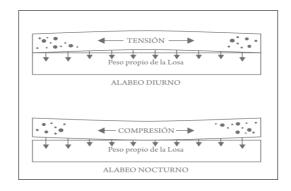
Alabeo de las Losas de los Pavimentos de Concreto
